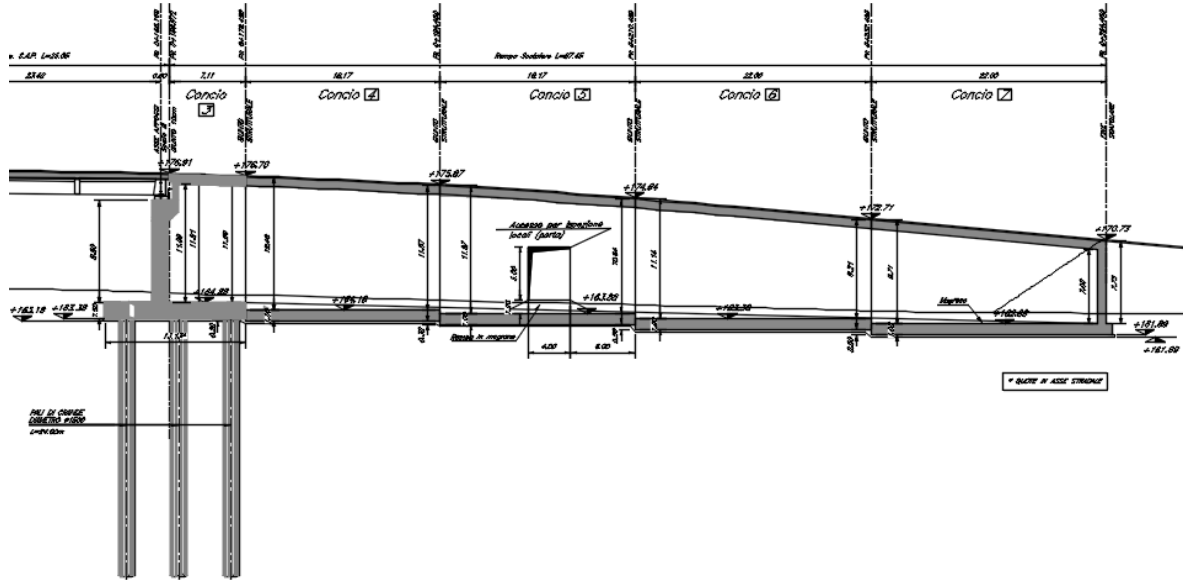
Sezione longitudinale lato spalla A
